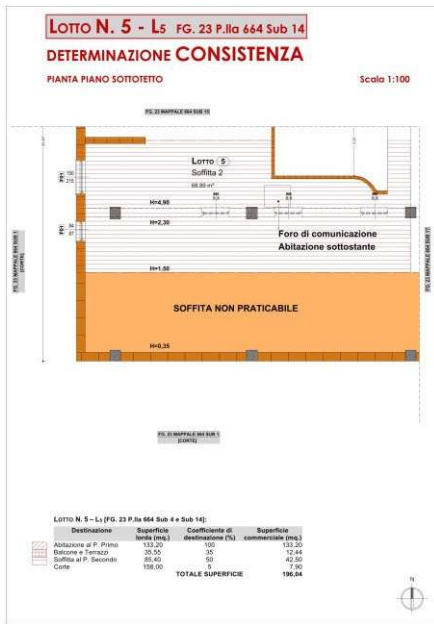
Determinazione consistenza Lotto L5 (ALL. 11).
